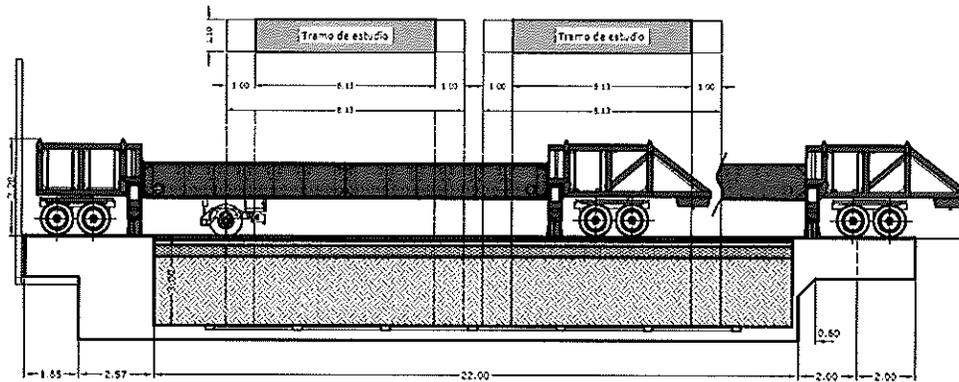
Vista Lateral de Colocación del HVS sobre Pista de Ensayo.
